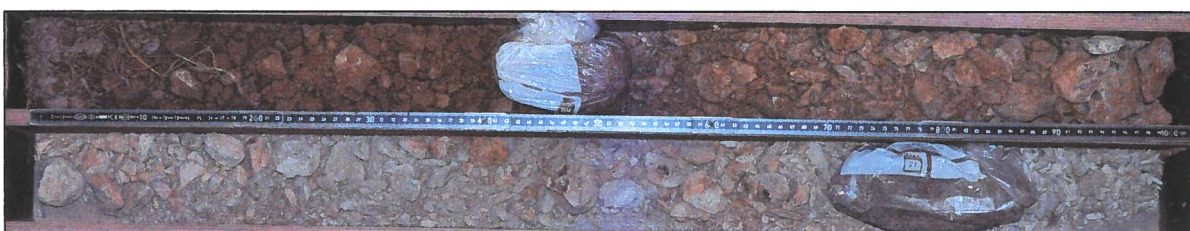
Erkundungsstelle 1 – Bohrgut Kleinrammbohrung
